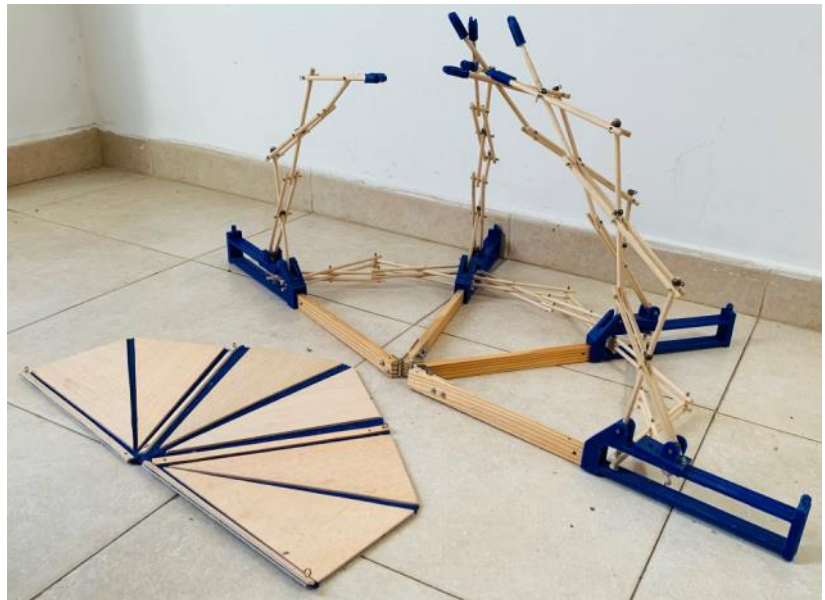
Maqueta de medio domo desplegable. Detalle bisagras para articular las vigas soporte y generar el movimiento abatible de la estructura de la plataforma
